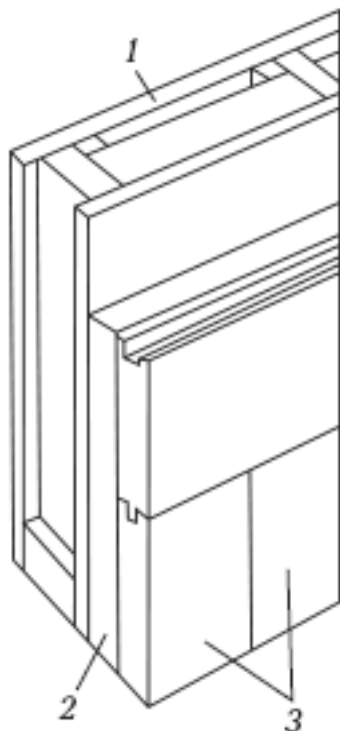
Утепление щитовой стены: 1 – легкая стена из гипсолит; 2 – утеплитель; 3 – гипсовая строительная плита
